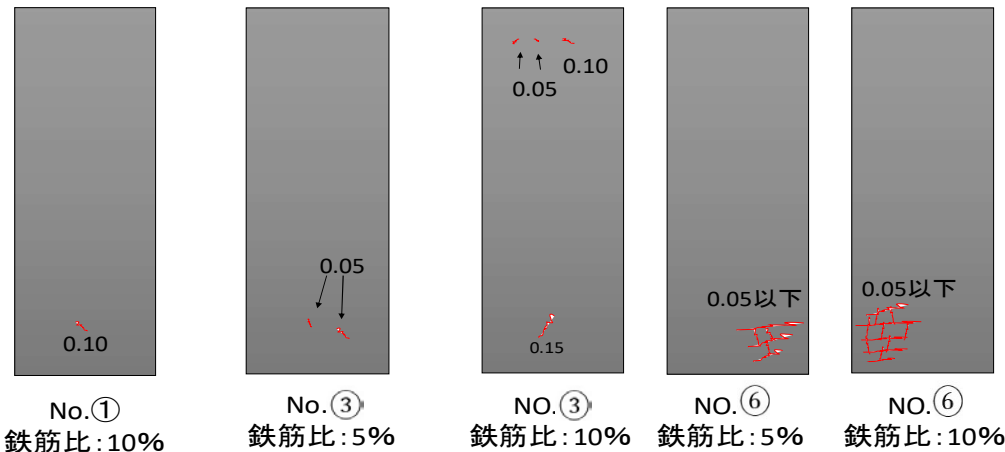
材令 9 週におけるひび割れ図 (ひび割れが確認された供試体のみ) (数値はひび割れ幅 (mm))
